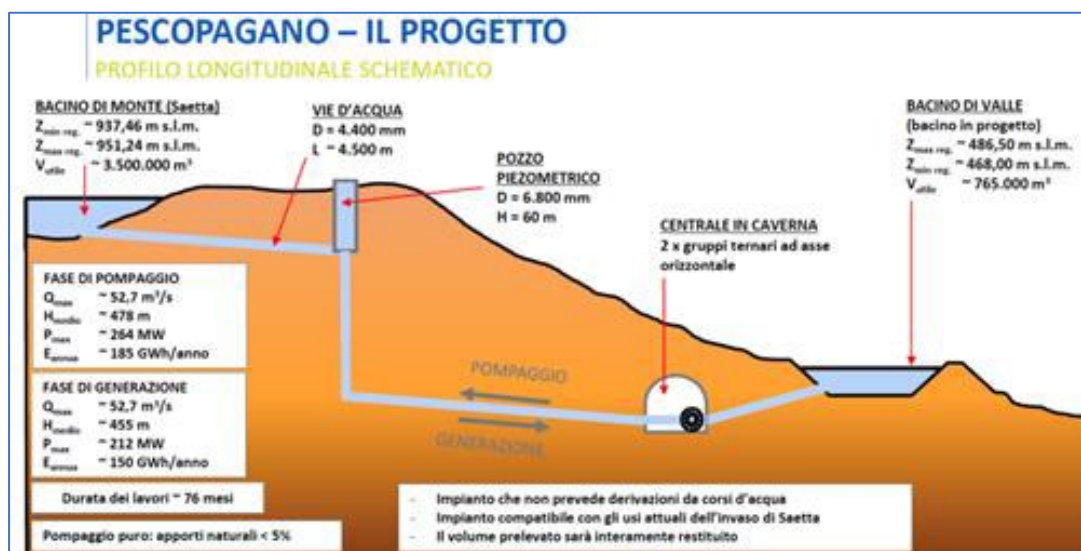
Schema del profilo longitudinale del progetto, i principali elementi progettuali
